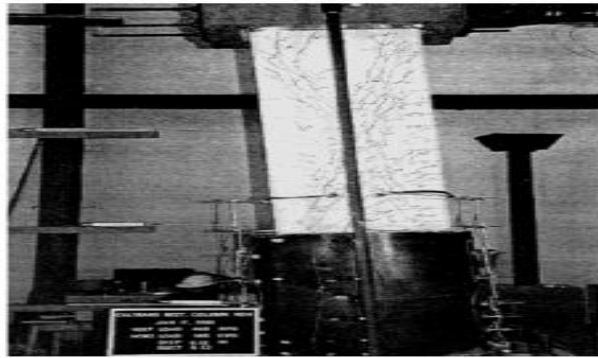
Barre de recouvrement d'une base de poteau rectangulaire renforcé avec une chemise en acier.
